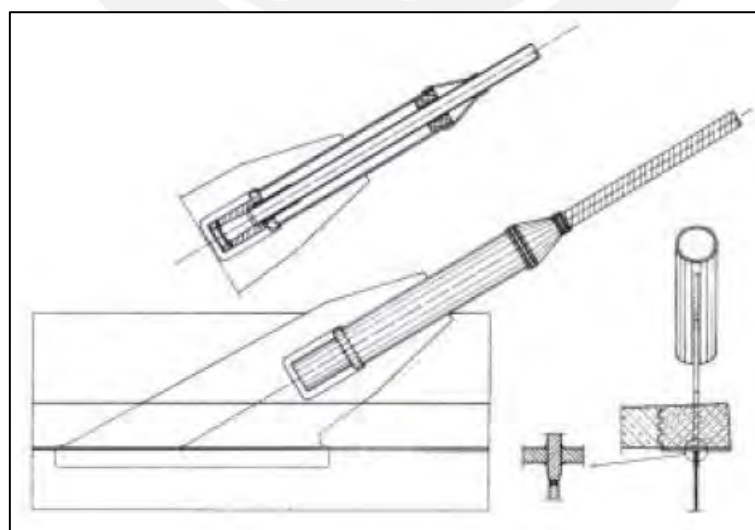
Extremo cilíndrico de cables, marca DSI (DSI, 2016).
